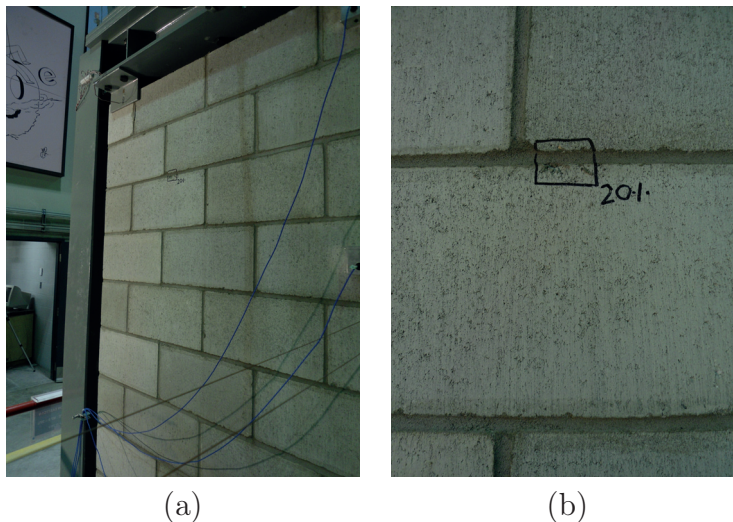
Photos de l'endommagement du mur 2 après l'essai MAL6-0.20 (a) vue globale de la façade avant du mur (b) vue rapprochée d'un joint endommagé
